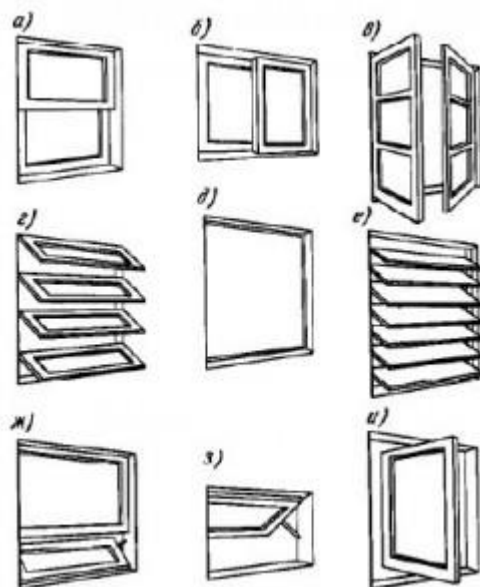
Виды окон по способу открывания; а — двойное раздвижное, б — раздвижное, в — створчатое, г — верхнеподвесное, д — глухое, е — жалюзийное, ж — с нижнеподвесной створкой, з — верхнеподвесное подвальное, и — на цапфах
